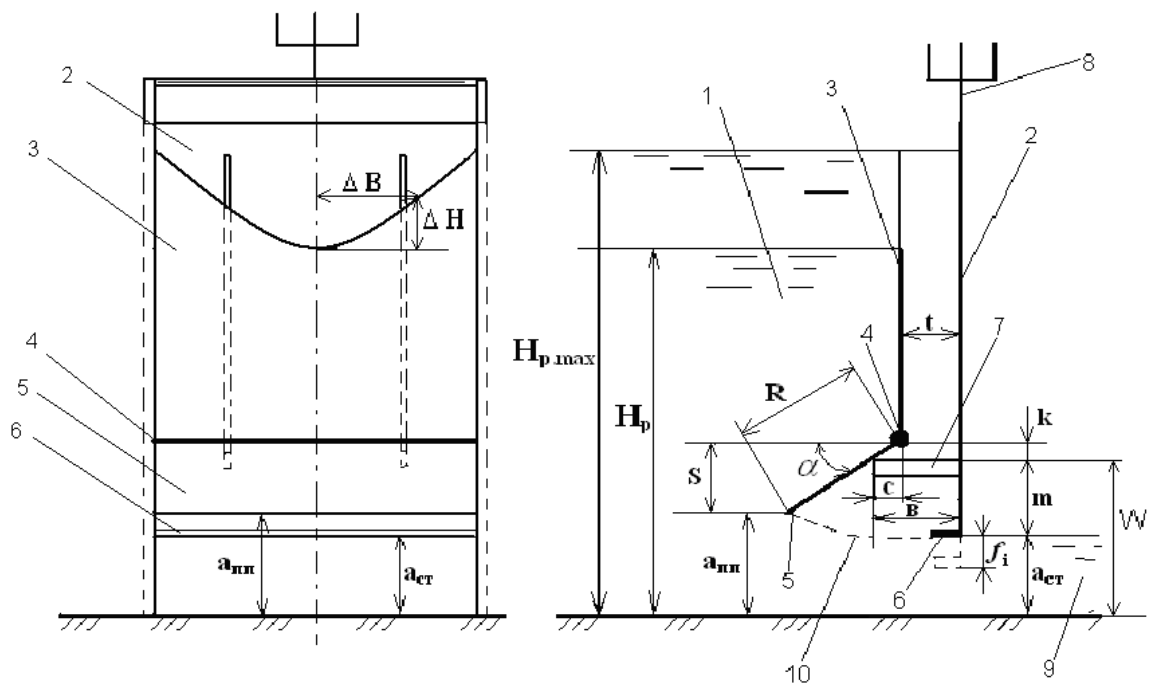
Расчетная схема усовершенствованной конструкции стабилизатора расхода: 1 – верхний бьеф; 2 – плоский затвор; 3 – передняя стенка; 4 – шарнир; 5 – поворотная пластина; 6 – горизонтальный козырек; 7 – штанга взаимодействия; 8 – подъемный винт; 9 – нижний бьеф; 10 – траектория сжатия струи; 11 – траектория смещения нижней грани затвора при регулировании;  $H_p$  – расчетный напор;  $H_{p, \text{max}}$  – максимальный расчетный напор;  $R$  – длина поворотной пластины;  $t$  – расстояние между плоским затвором и передней стенкой;  $\alpha$  – угол перемещения поворотной пластины;  $s$  – расстояние между плоским затвором и передней стенкой;  $a_{\text{пл}}$  – открытие поворотной пластины;  $a_{\text{ст}}$  – открытие плоского щитового затвора;  $v$  – длина штанги взаимодействия;  $c$  – длина участка штанги взаимодействия, сопрягающегося с вращающейся пластиной
